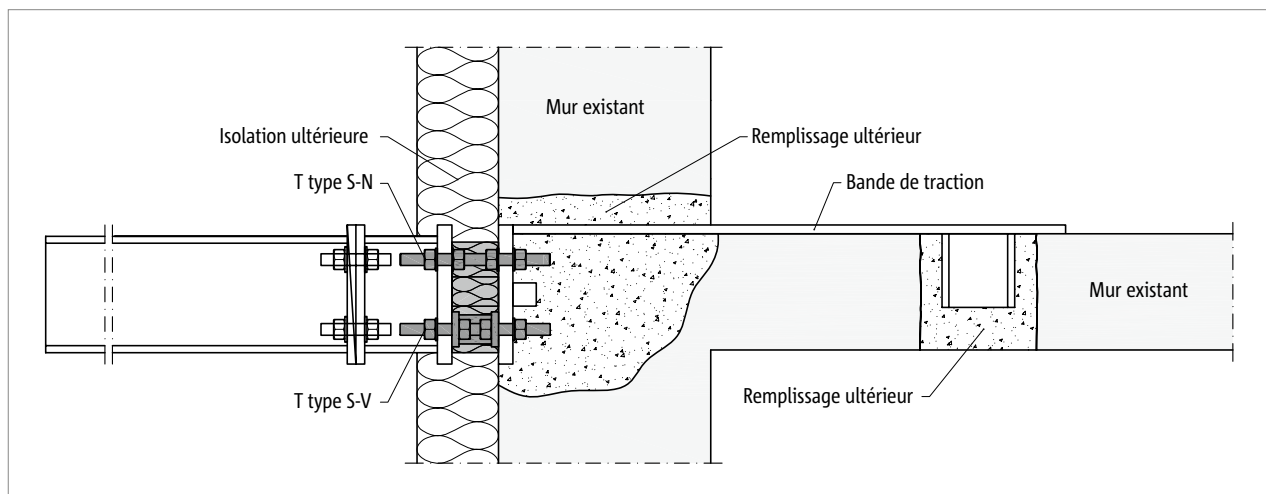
Schöck Isokorb® T type S-N et T type S-V : balcon en acier avec adaptateur, en porte-à-faux, posé ultérieurement ; relié à la dalle en béton armé existante par une bande de traction
